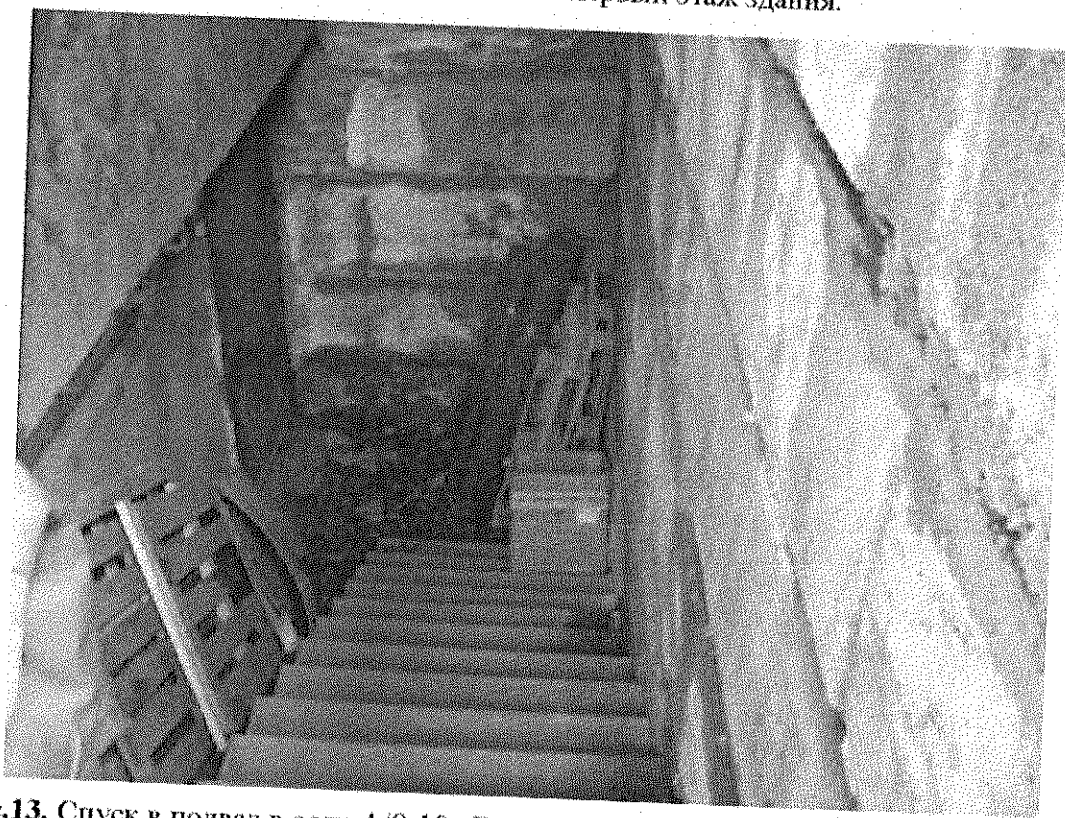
Спуск в подвал в осях А/8-10. Весь этаж в котором расположены складские помещения находится ниже планировочного уровня земли.
